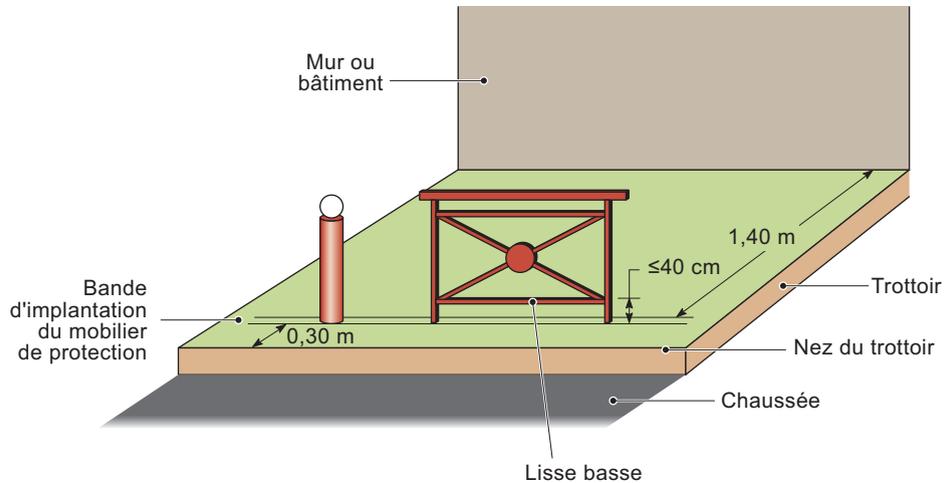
Exemple d'implantation de poteaux le long du trottoir.
